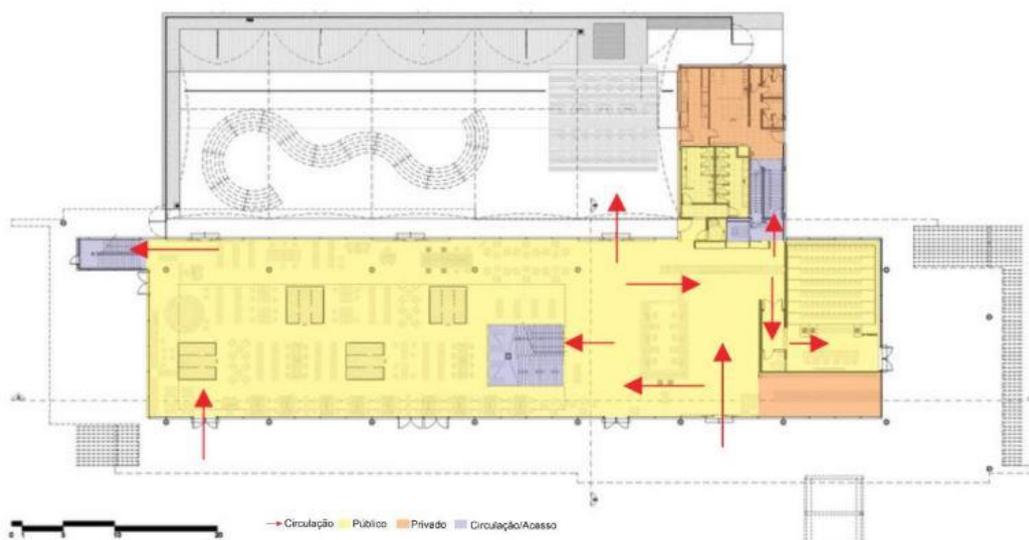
Plantas técnicas do projeto Biblioteca São Paulo
